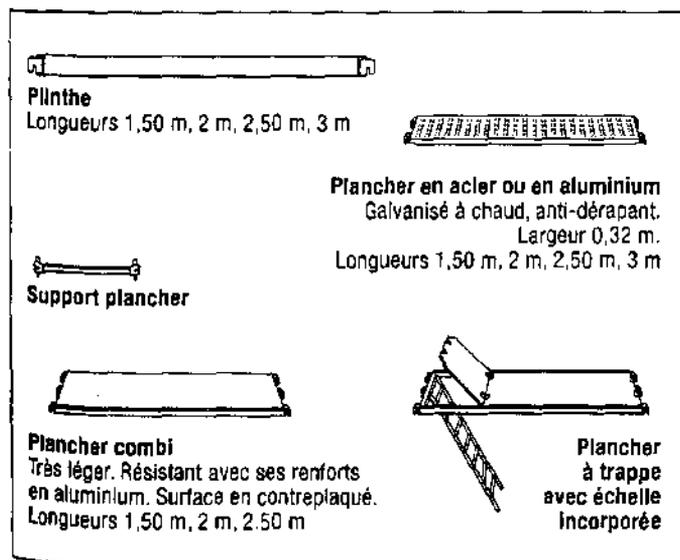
Plancher d'échafaudage à cadres préfabriqués.
